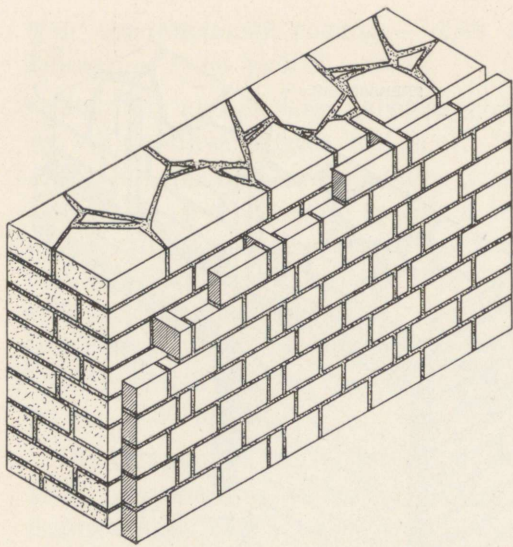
Облицовка плитняковой стены кирпичем. Облицовка прикреплена к плитневой стене прокладными тычковыми кирпичами (8 штук на м²).
